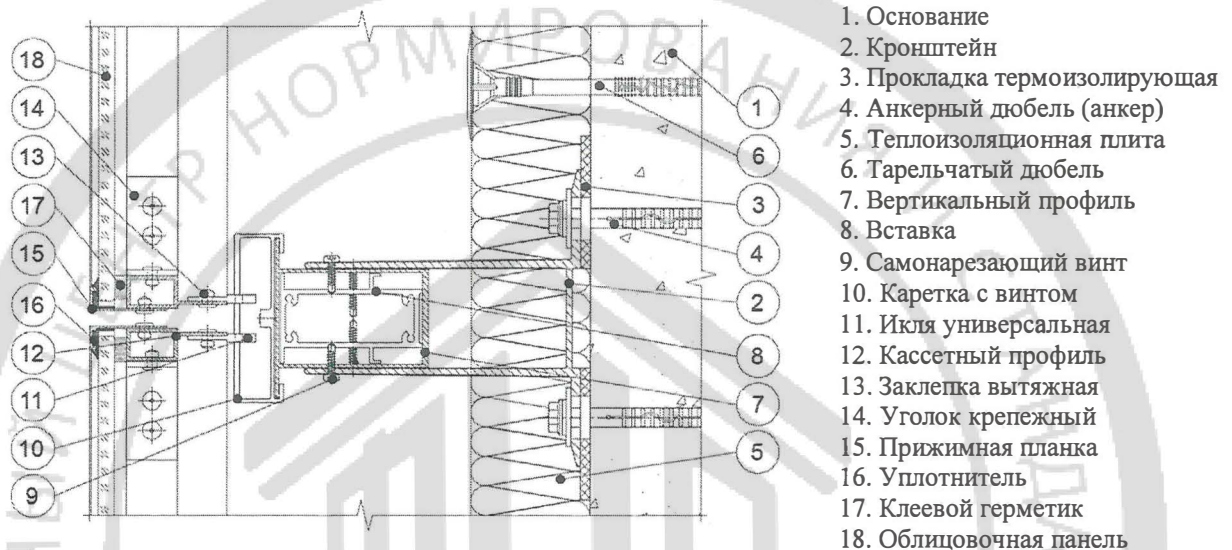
Горизонтальный разрез фасадной системы «MLK-v-300» (второй вариант конструктивного исполнения несущего каркаса)
